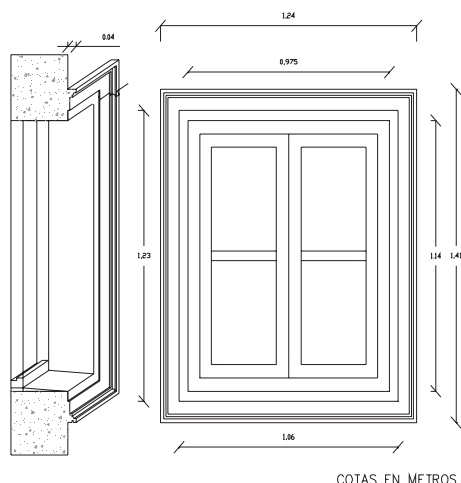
Plano del diseño del enmarcado mediante terrajas de las ventanas de la fachada norte.
